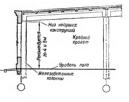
5. Высота зданий, оборудованных мостовыми кранами.
